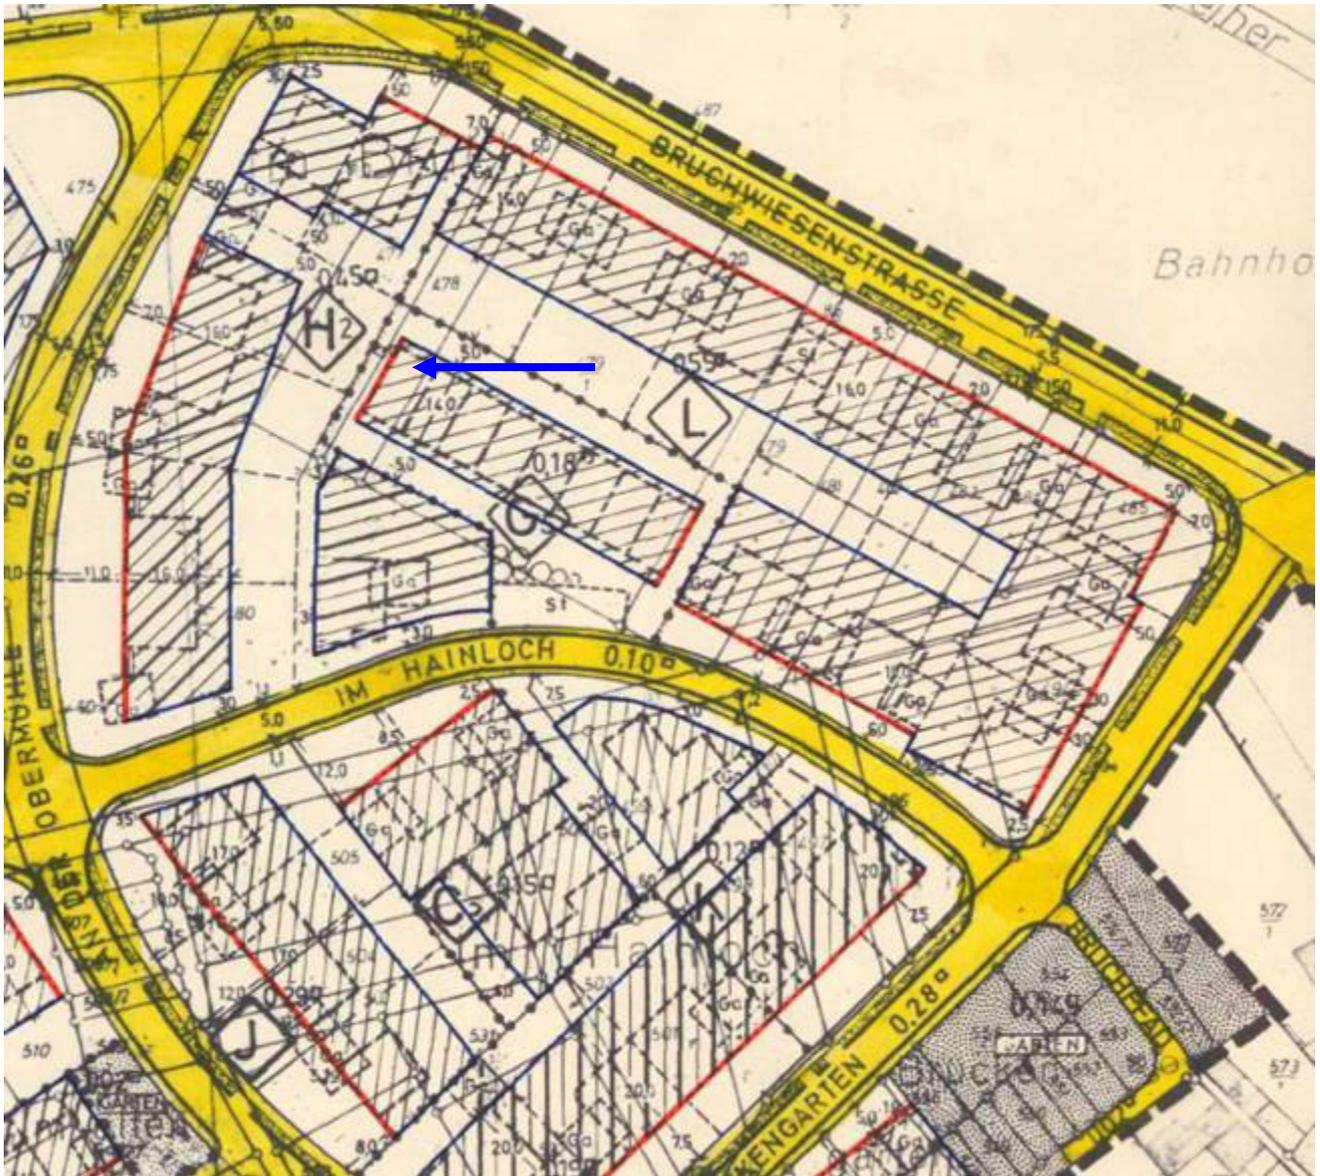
Plan zum Baulastenblatt Nr. 12012 (auszugsweise); Quelle: Kreisverwaltung Offenbach; Bauaufsicht
